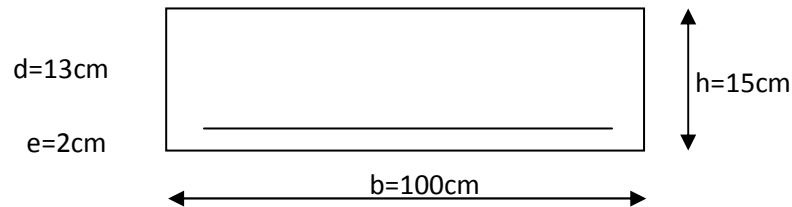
Schéma statique de ferrailage d'escalier à l'ELU.
